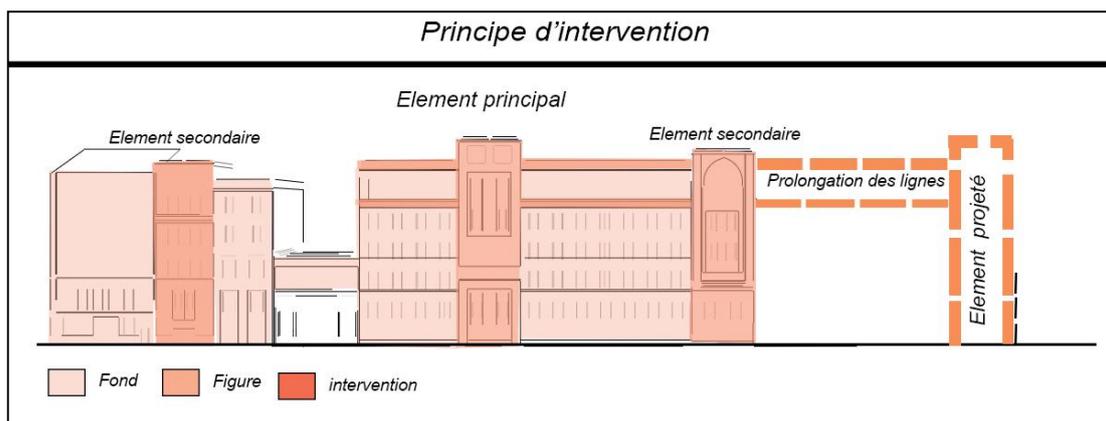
logique d'intervention sur la façade principale de l'îlot source auteur
